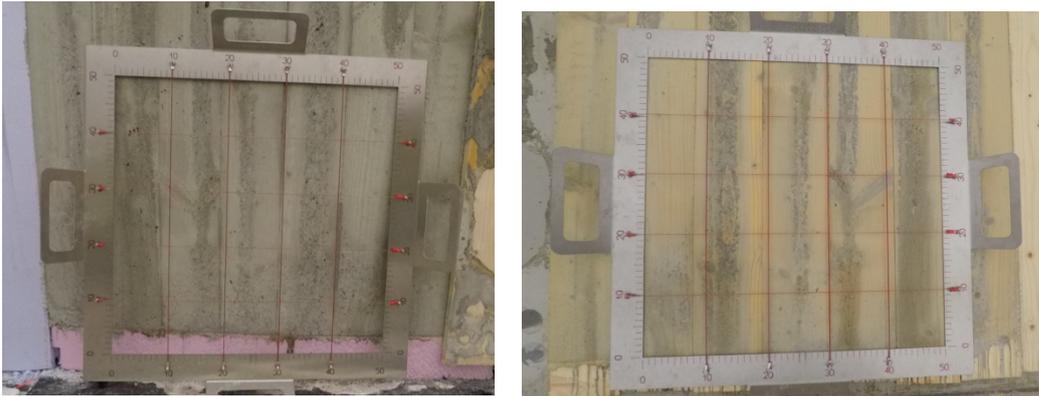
Vergleich Sichtbetonoberfläche mit Schalhaut
